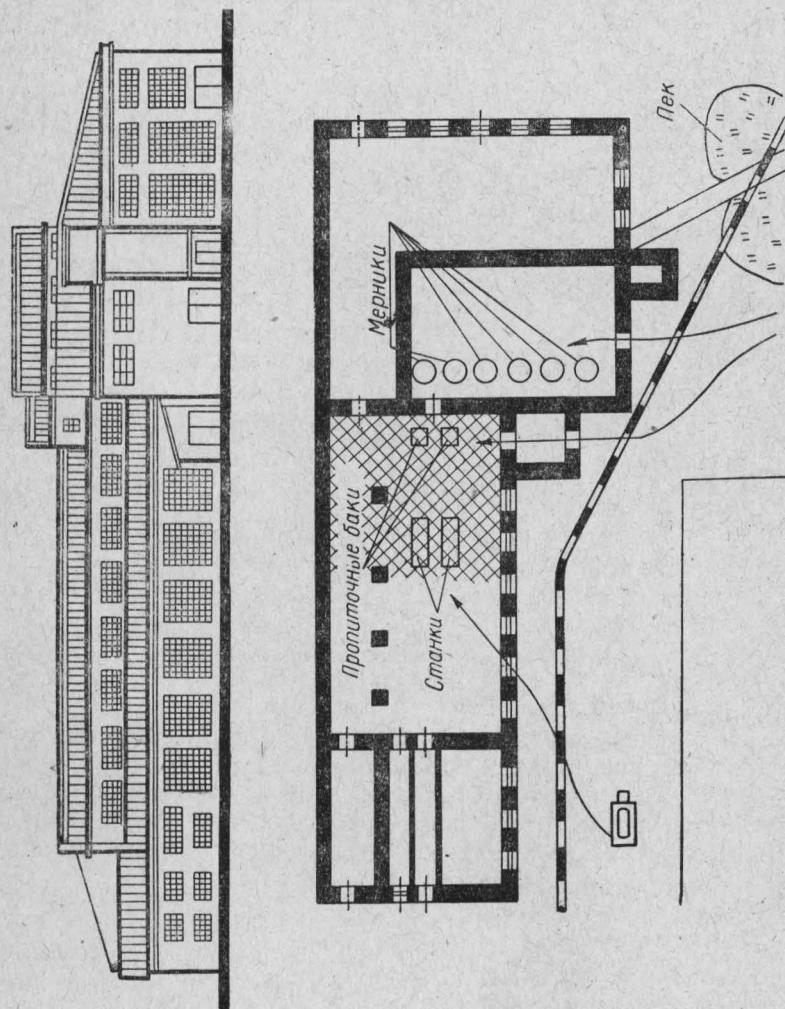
Общий вид корпуса, обстановка пожара и расстановка сил дежурного караула
